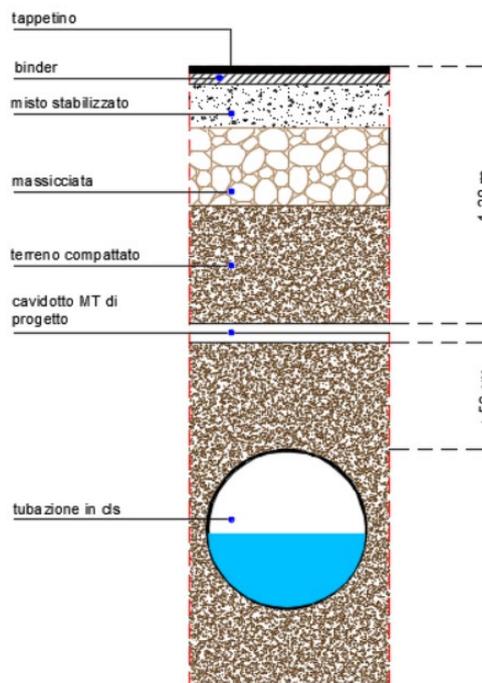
Schema tipologico di risoluzione dell'interferenza che prevede il passaggio del cavidotto sopra l'opera di canalizzazione e nel pacchetto stradale
